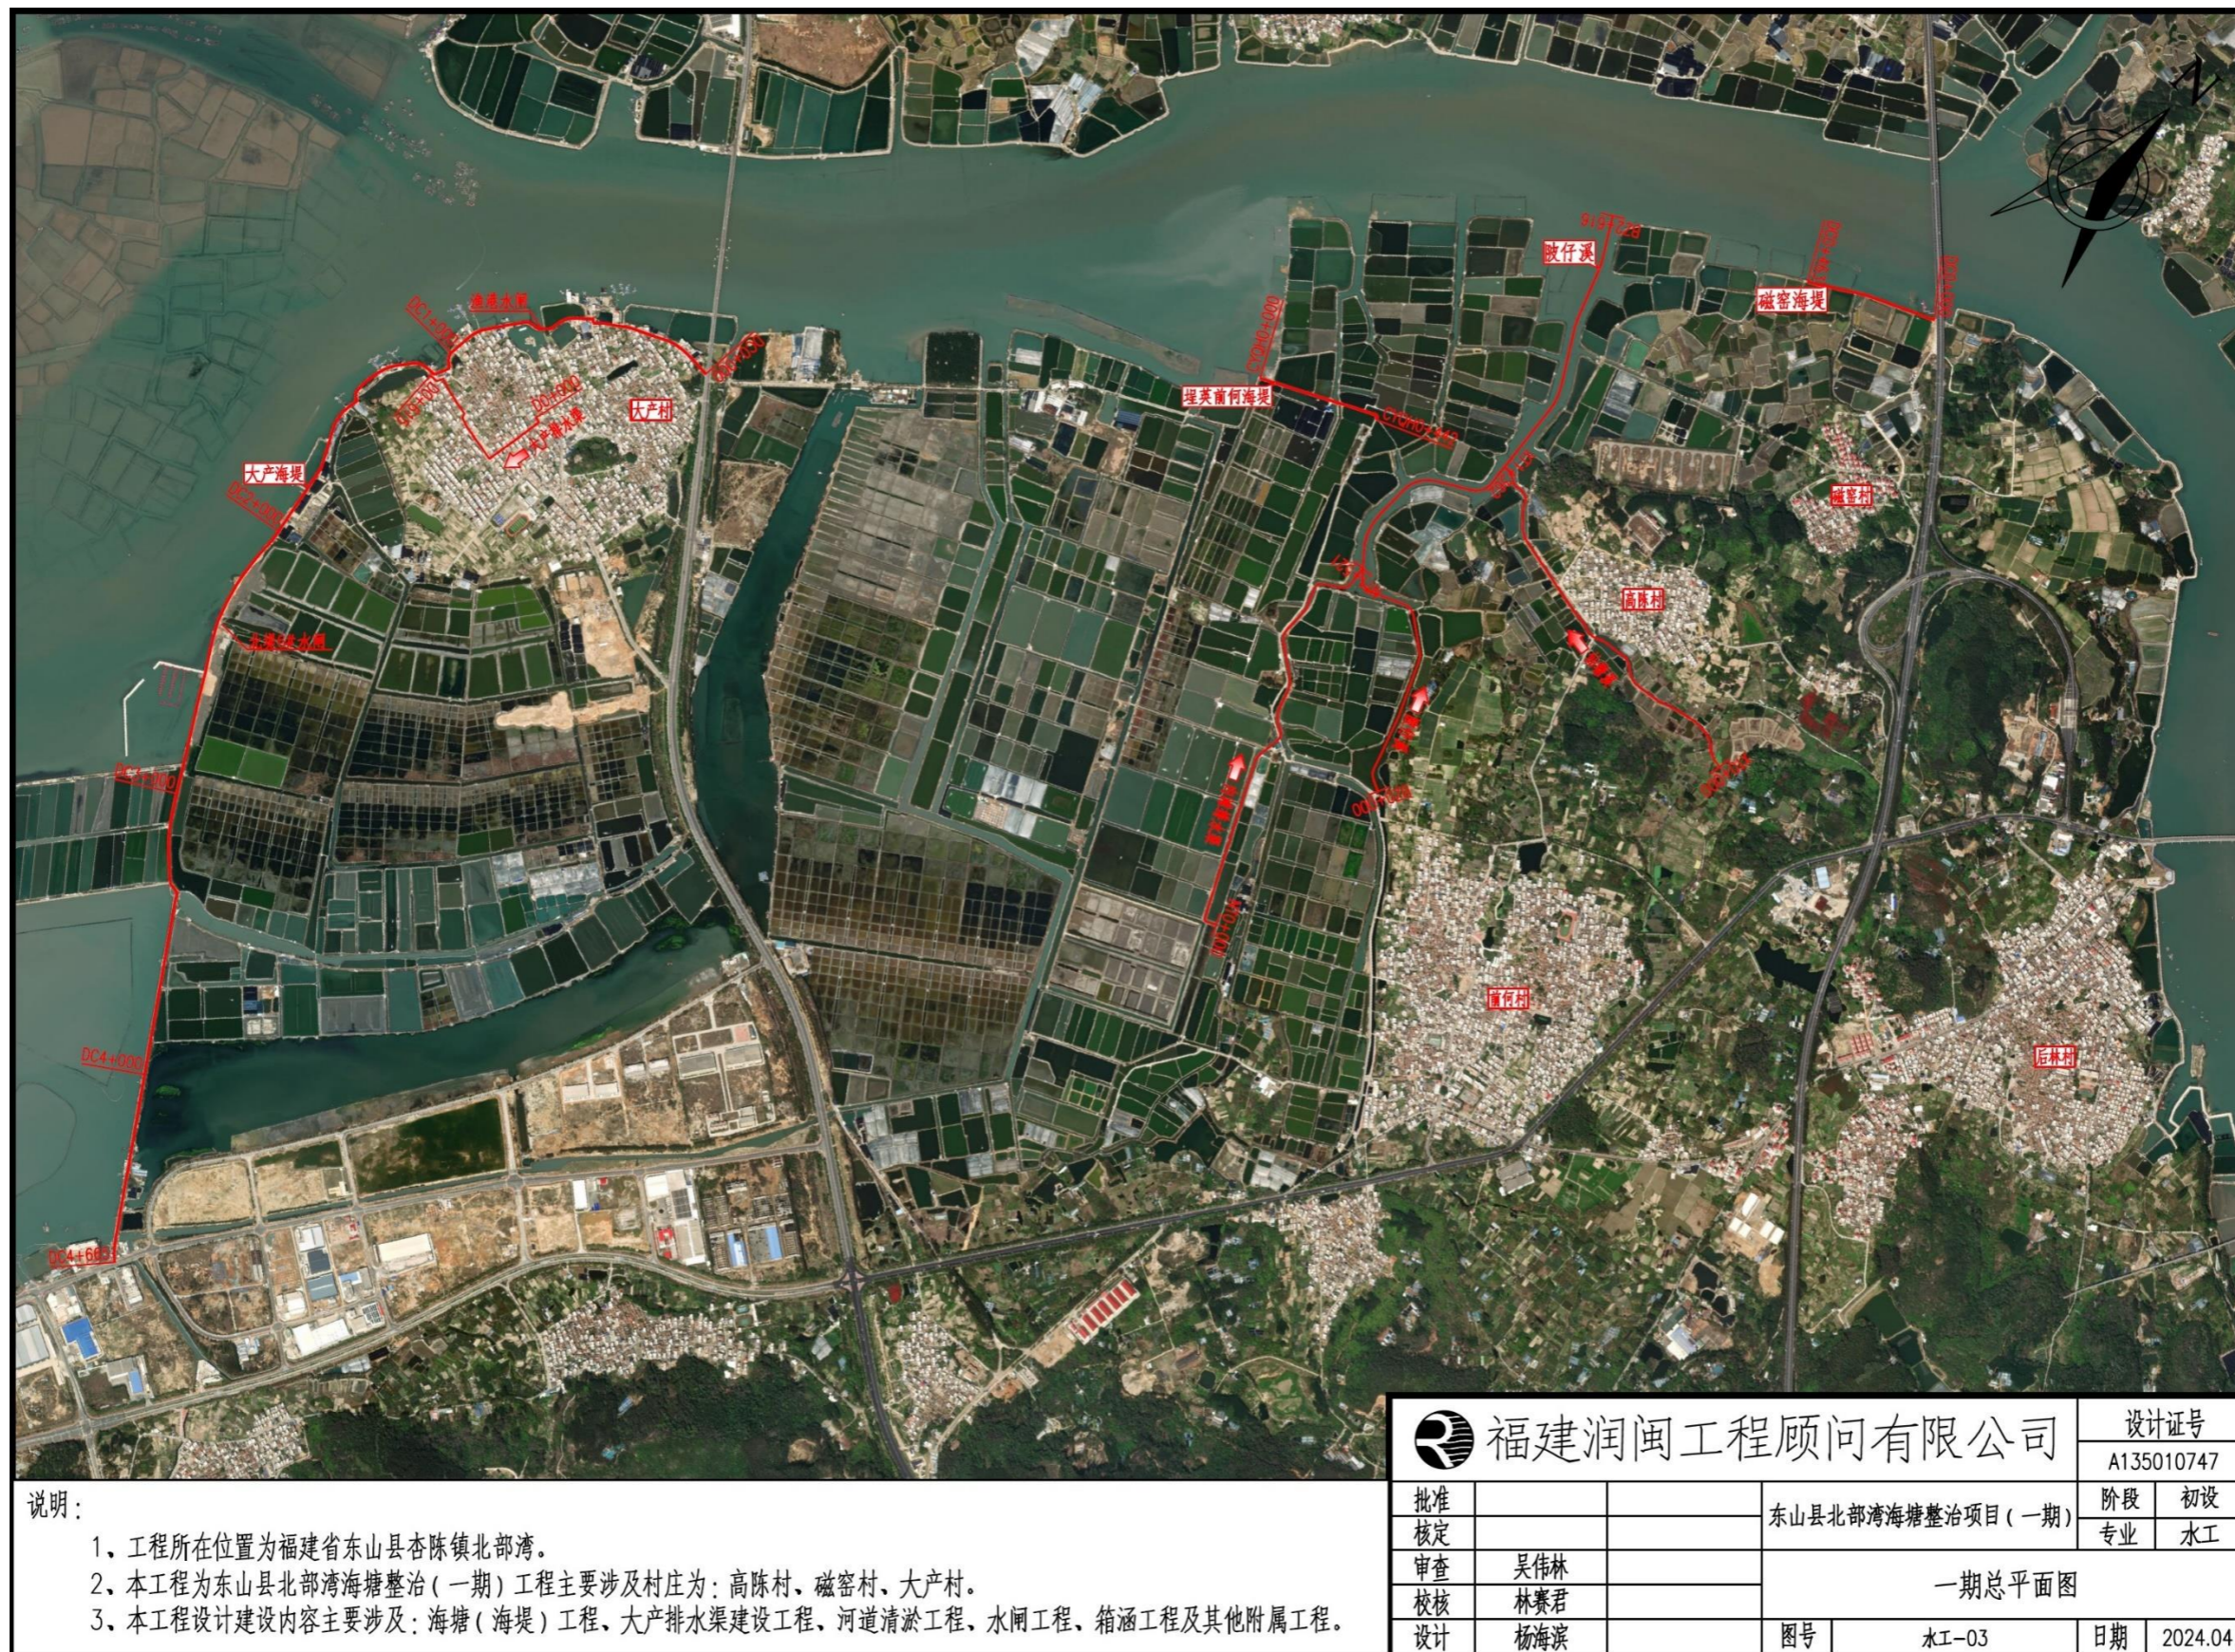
东山县北部湾海塘整治项目一期工程总平面布置图
